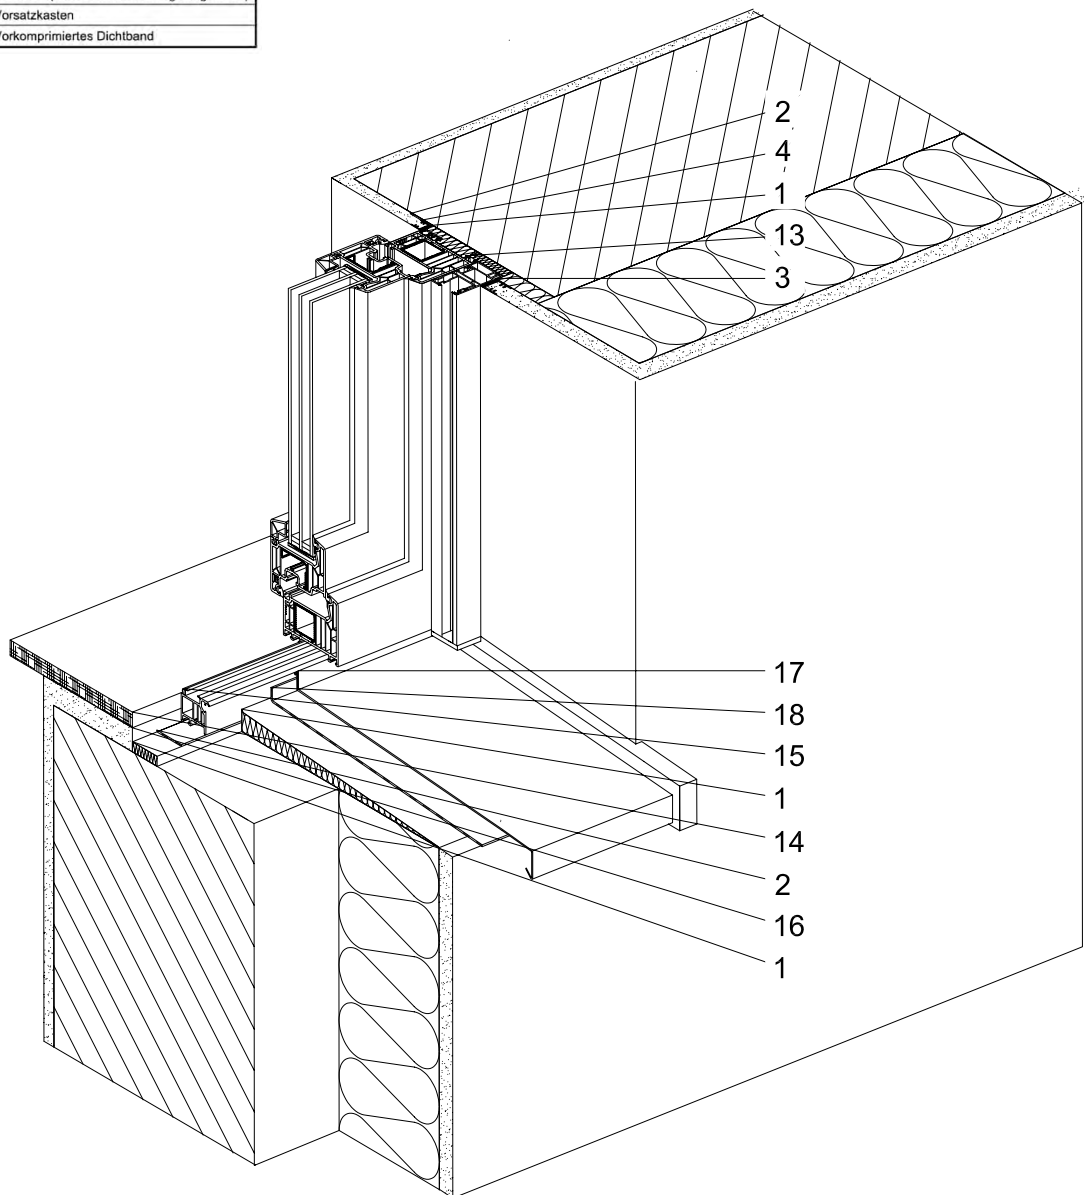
Darstellung der Abdichtung bei Anschluss Brüstung/Laibung außen
